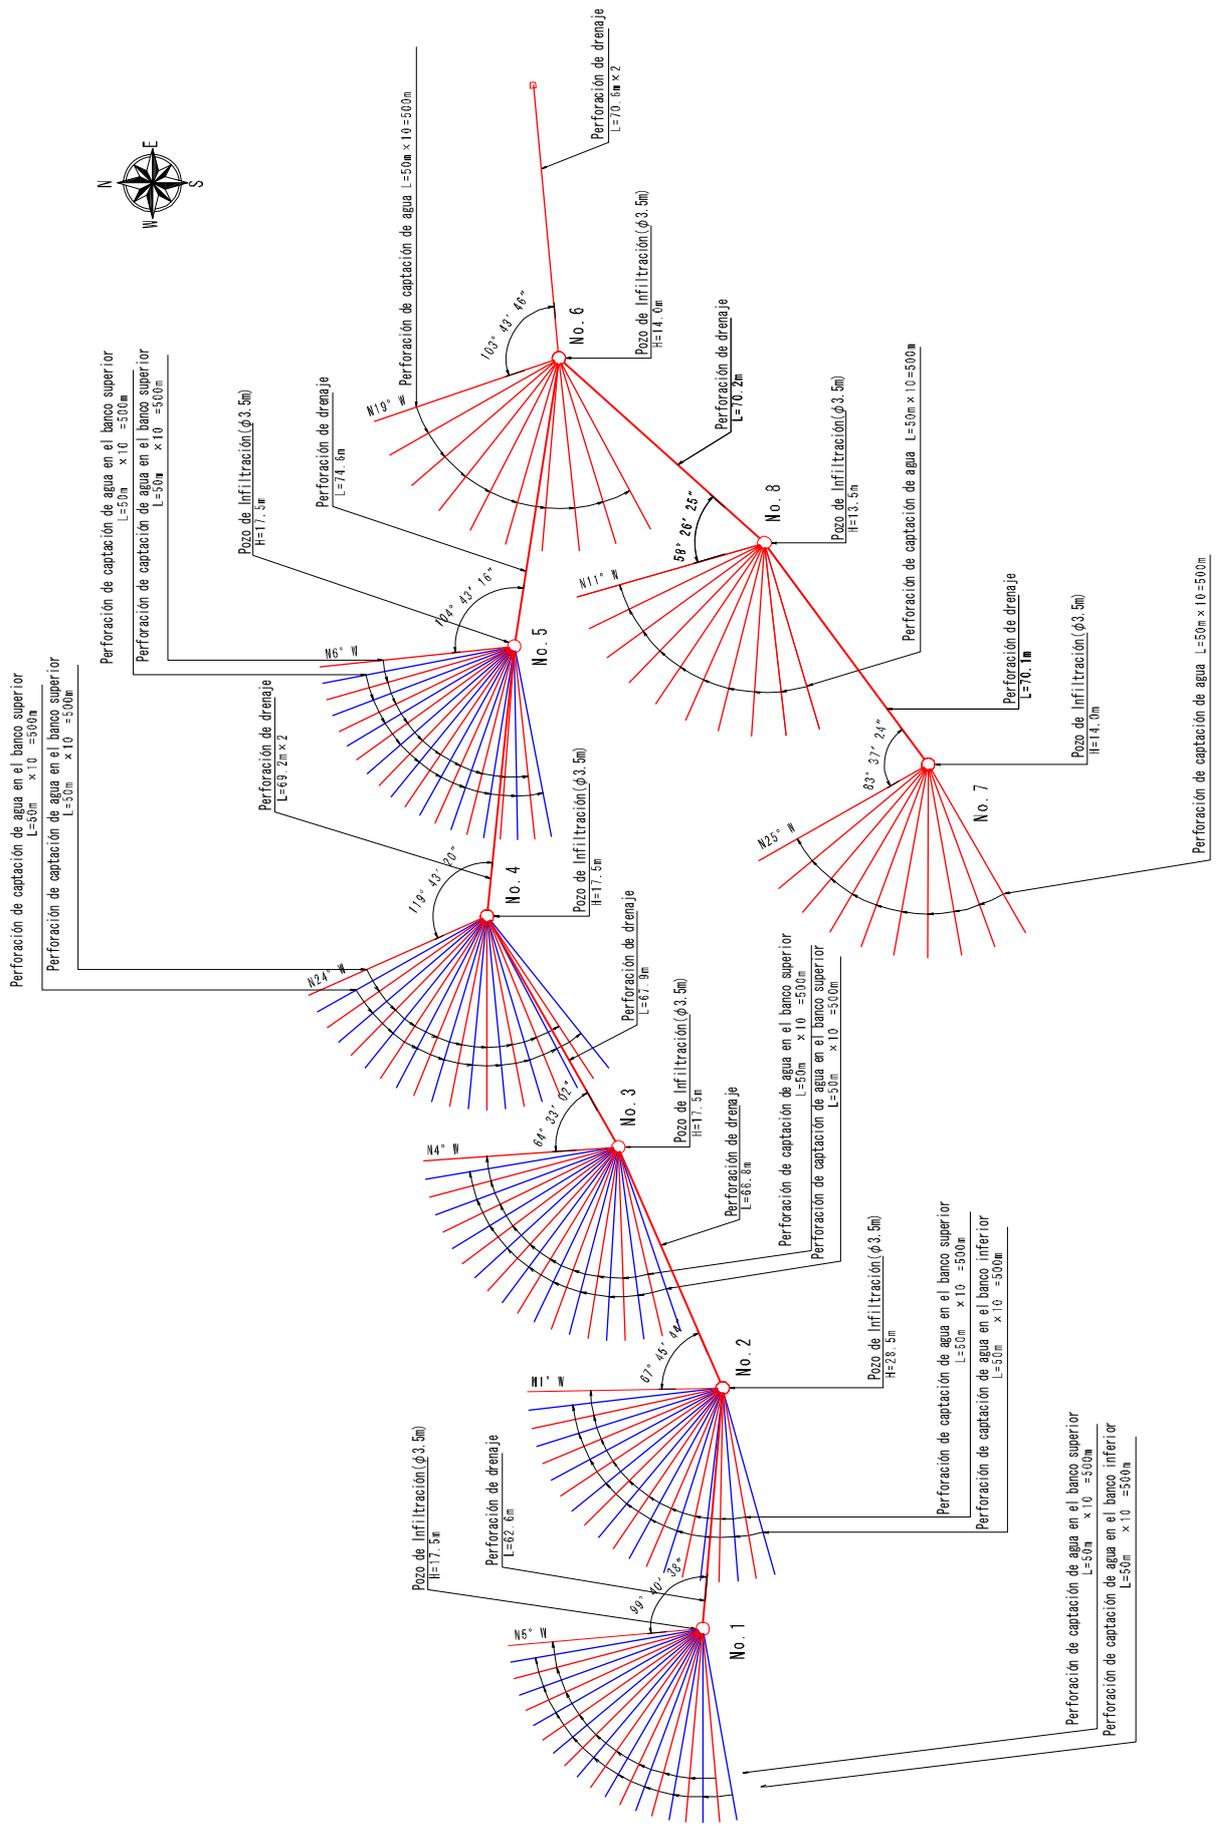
Plano de disposición plana de los pozos de infiltración (El Berrinche)
